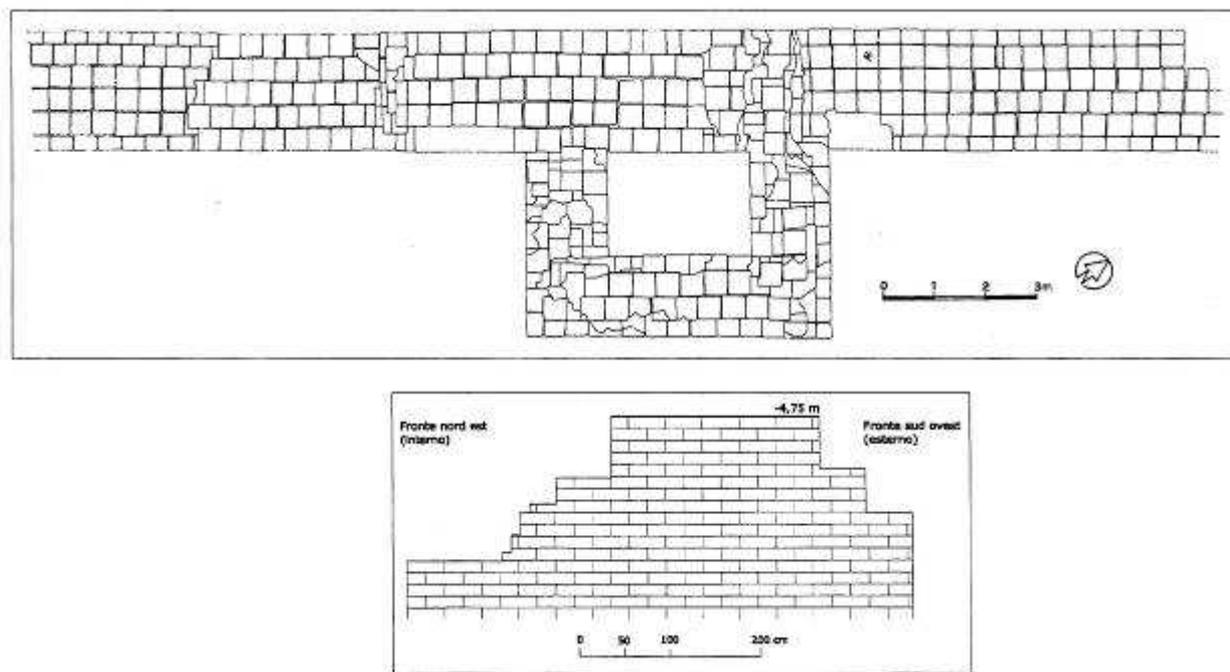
Ravenna. Pianta e prospetto di un tratto della cinta difensiva (MANZELLI 2000)
